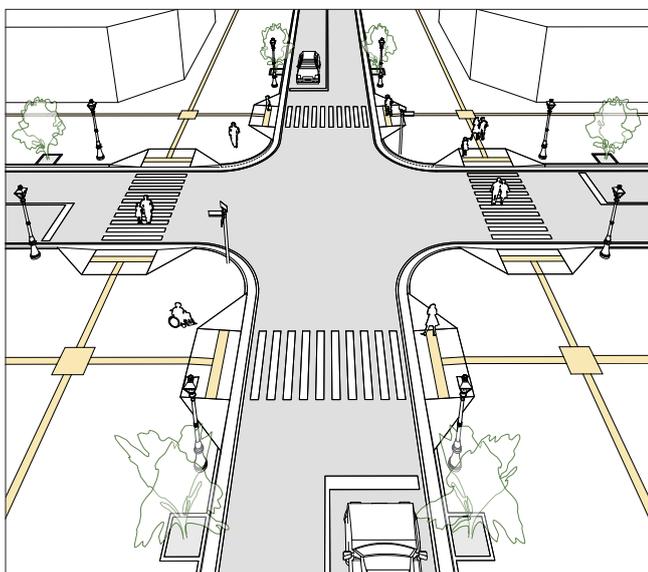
Cruzamento com aplicação de piso tátil e rebaixamento de calçada.
